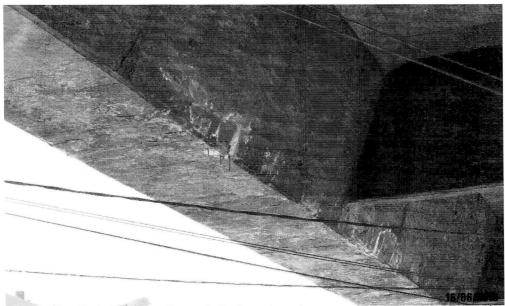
Detalhe da face inferior da viga com desplacamento de concreto e com eflorescência.
